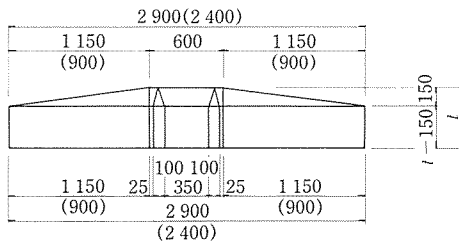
クロスタイプ構造一般図 (C 300 タイプ)
